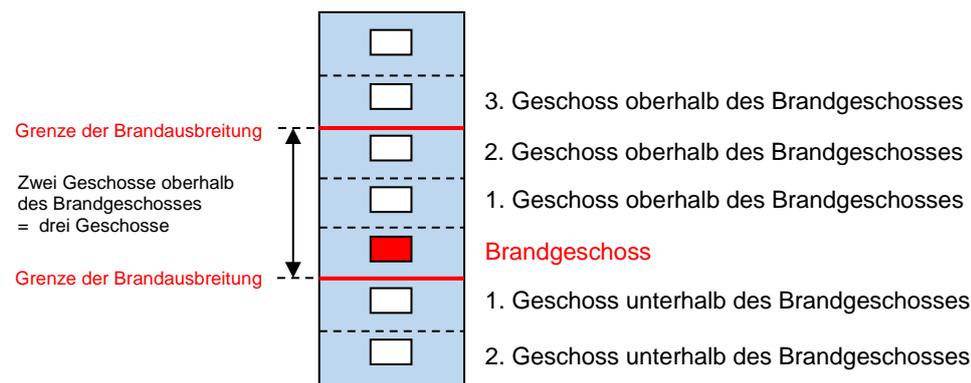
Darstellung «generelles Schutzziel für Fassaden» (Schweiz) – «drei Geschosse»
